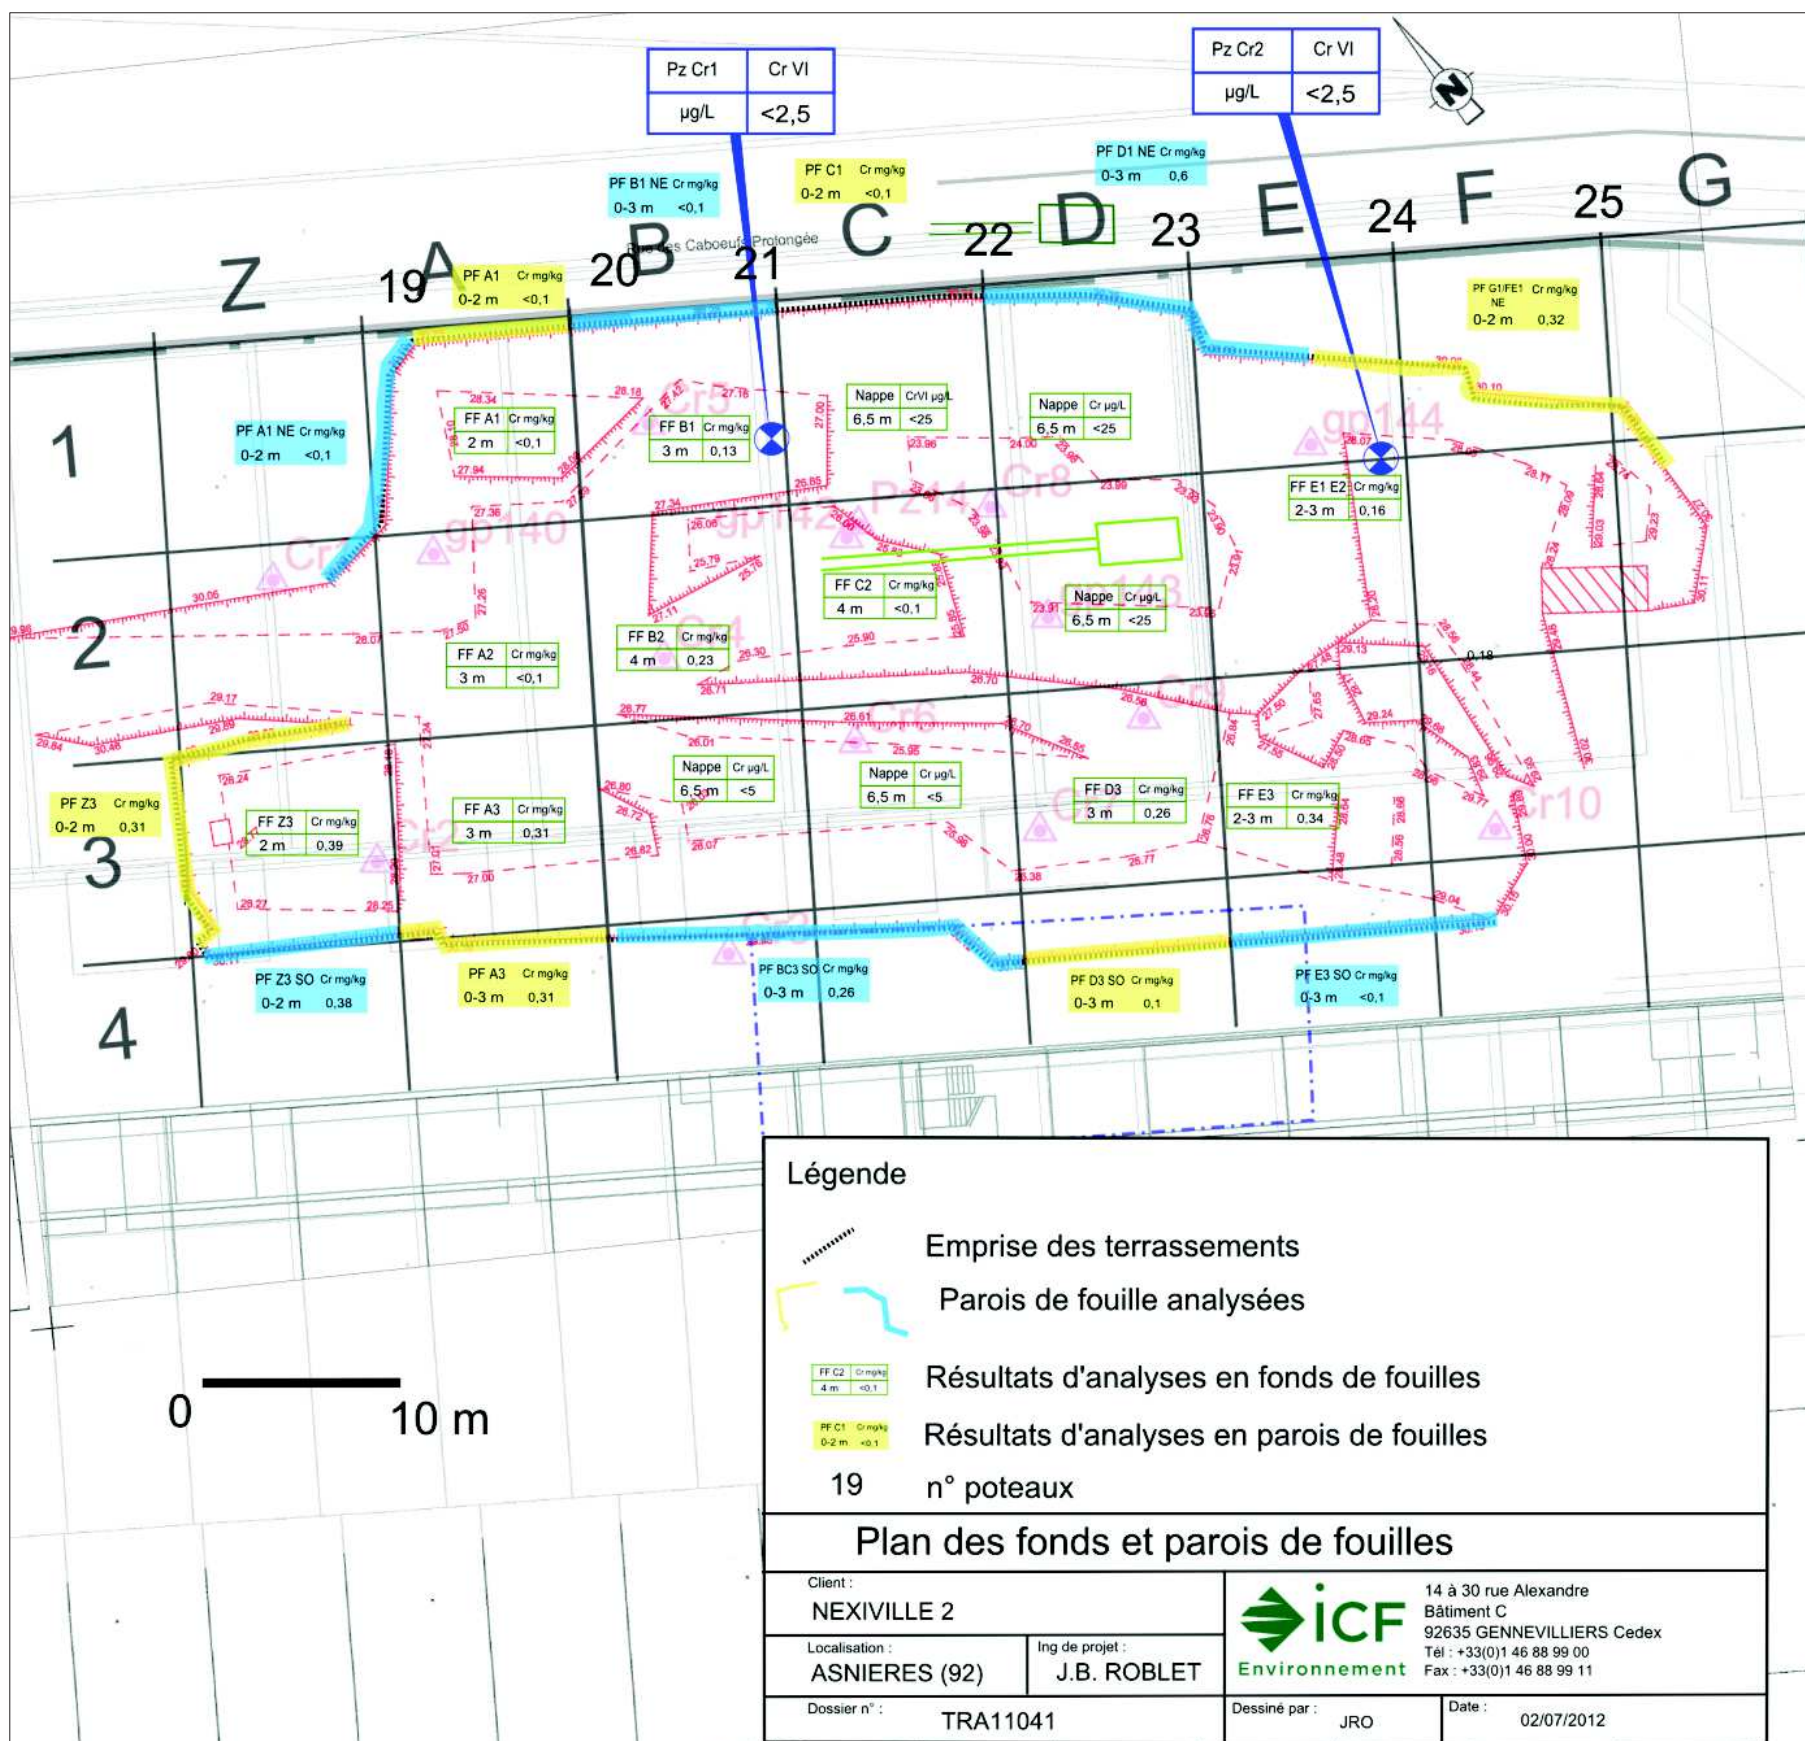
Plan de réception de fond et parois de fouilles de la zone excavée
